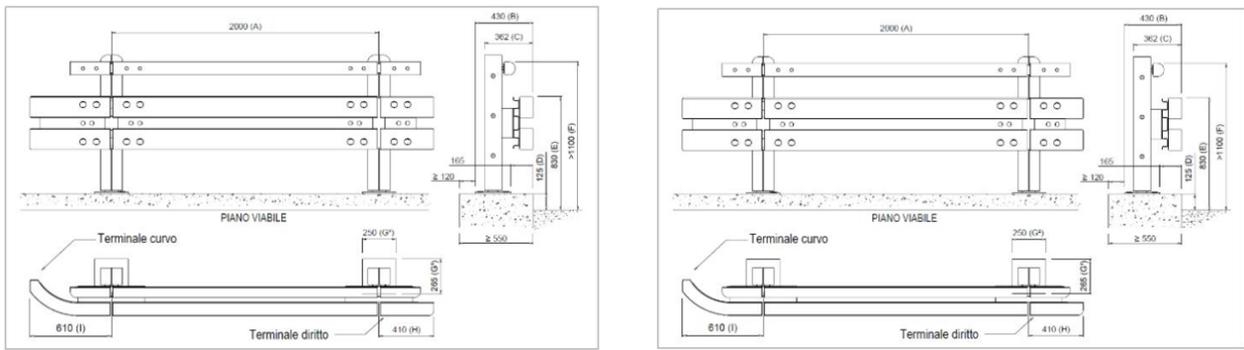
Pianta, prospetto e sezione tipo della barriera H1 BL e H2 BP in legno e Corten
